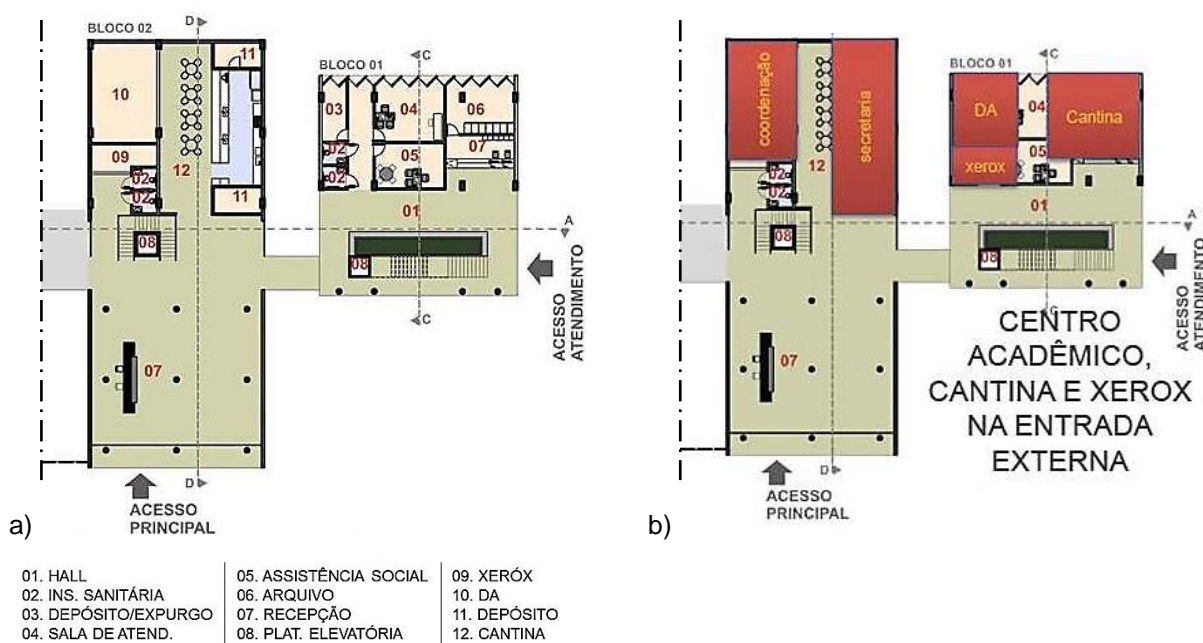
Planta do primeiro pavimento da Escola de Medicina – blocos 01 e 02
